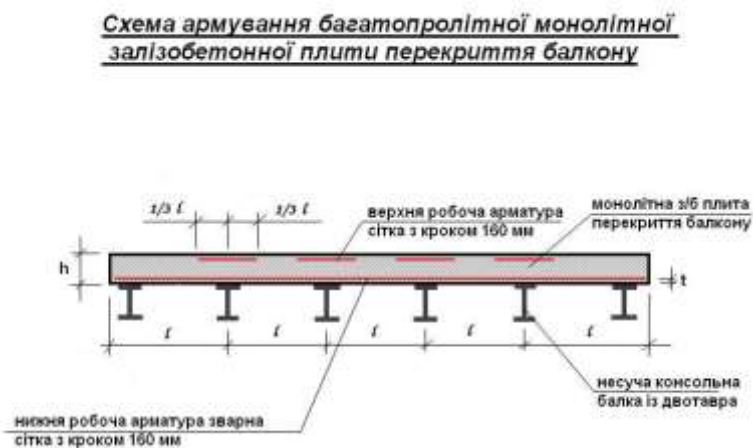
Схема армування багатопролітної монолітної залізобетонної плити перекриття балкону
